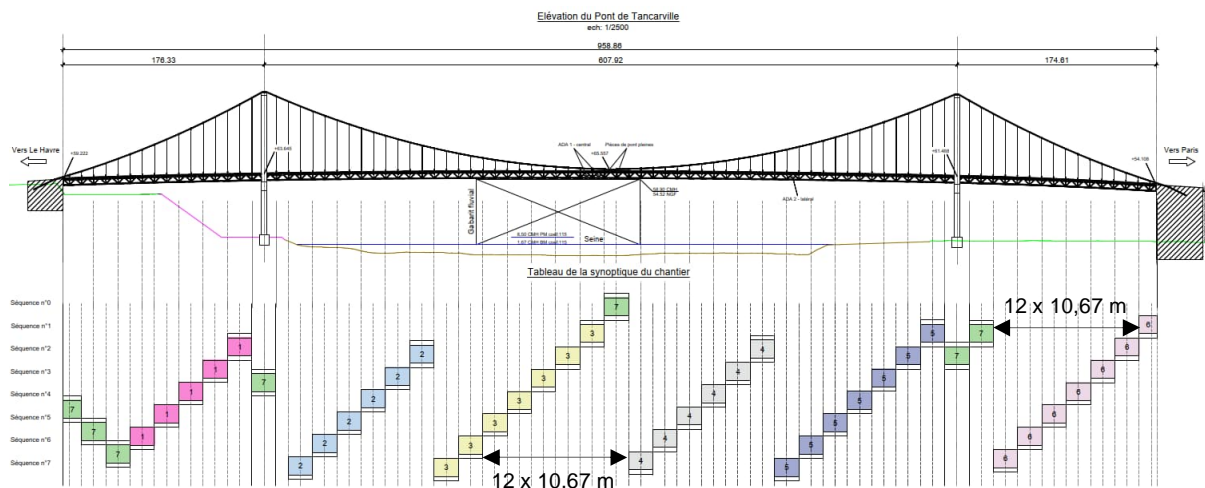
Coupe longitudinale sur l'ouvrage présentant les distances minimales entre plateformes
